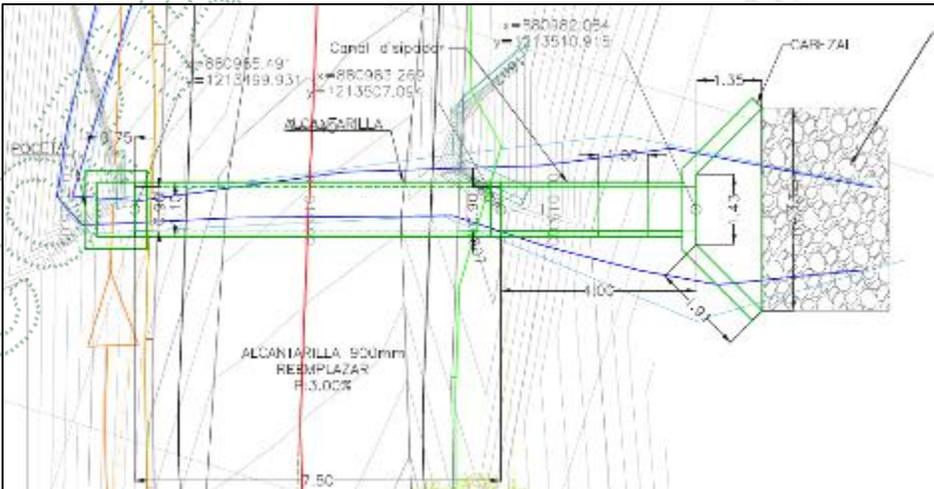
(41)			Tipo de la obra			Box Culvert abscisa K02+957
